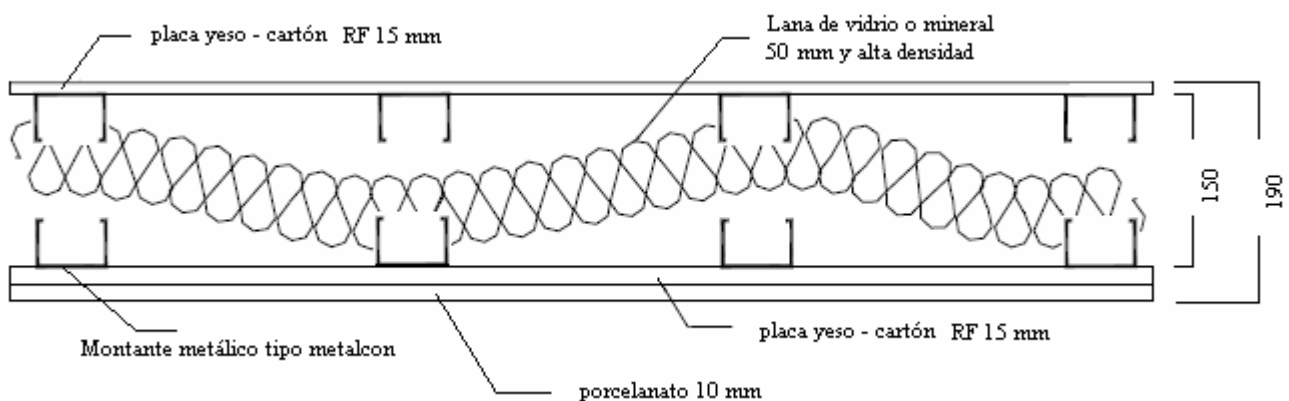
Muro Interior – exterior modificado  $R_w$  68.
